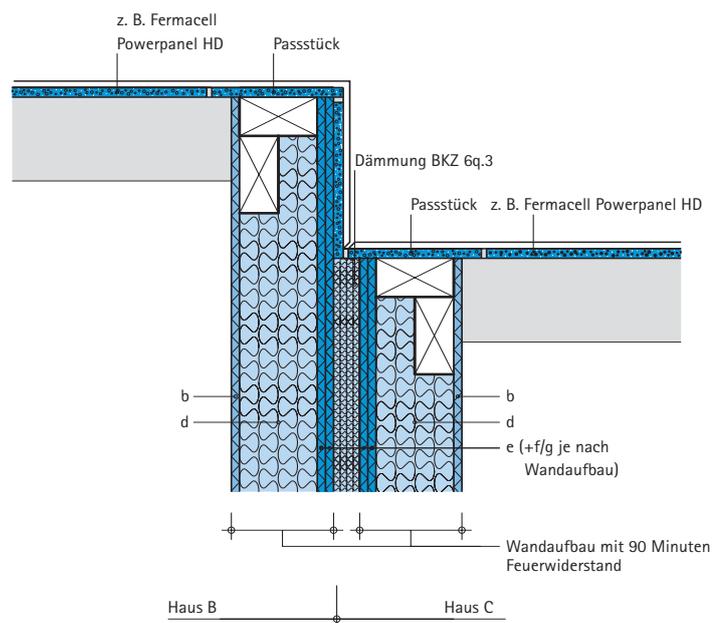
Fassadenanschluss mit versetzten Fassadenflächen und verputzter Aussenwand
